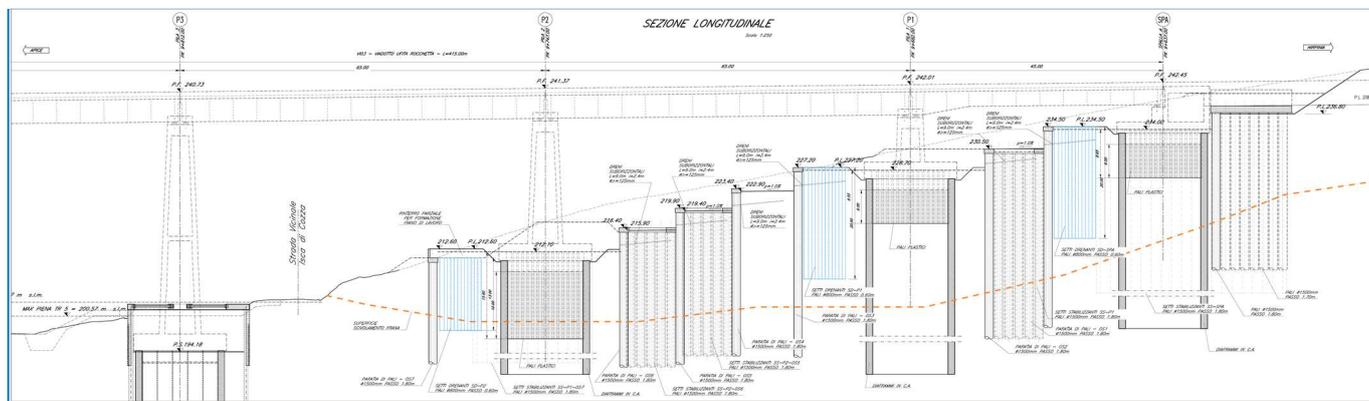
Profilo longitudinale con l'insieme degli interventi di stabilizzazione del Versante e Fondazione delle Pile
